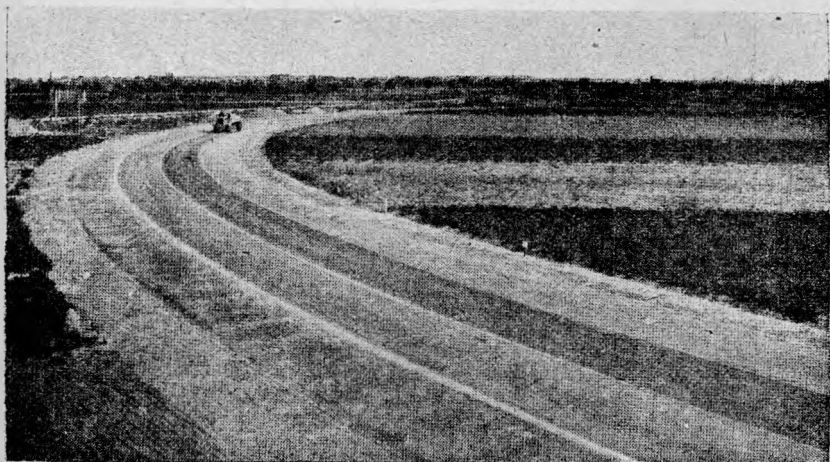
Stradă de beton pentru încercare construită în Braunschweig.
